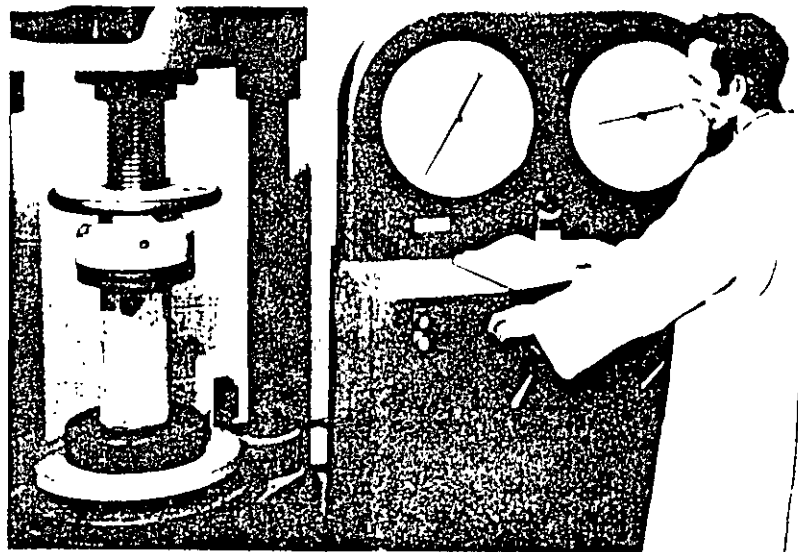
Ensayo a compresión de un cilindro de hormigón.
